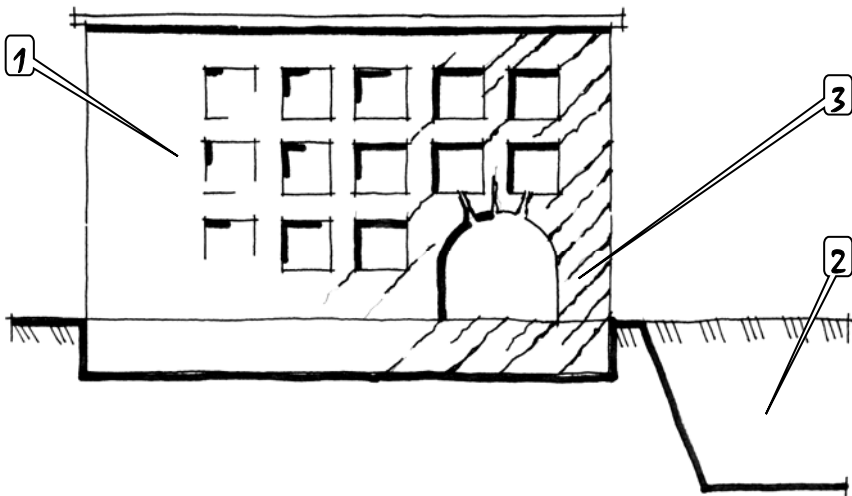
Пошкодження при влаштуванні котлованів біля існуючих будівель: 1 – існуюча будівля; 2 – котлован під фундаменти нової будівлі; 3 – зона появи і розвитку тріщин
